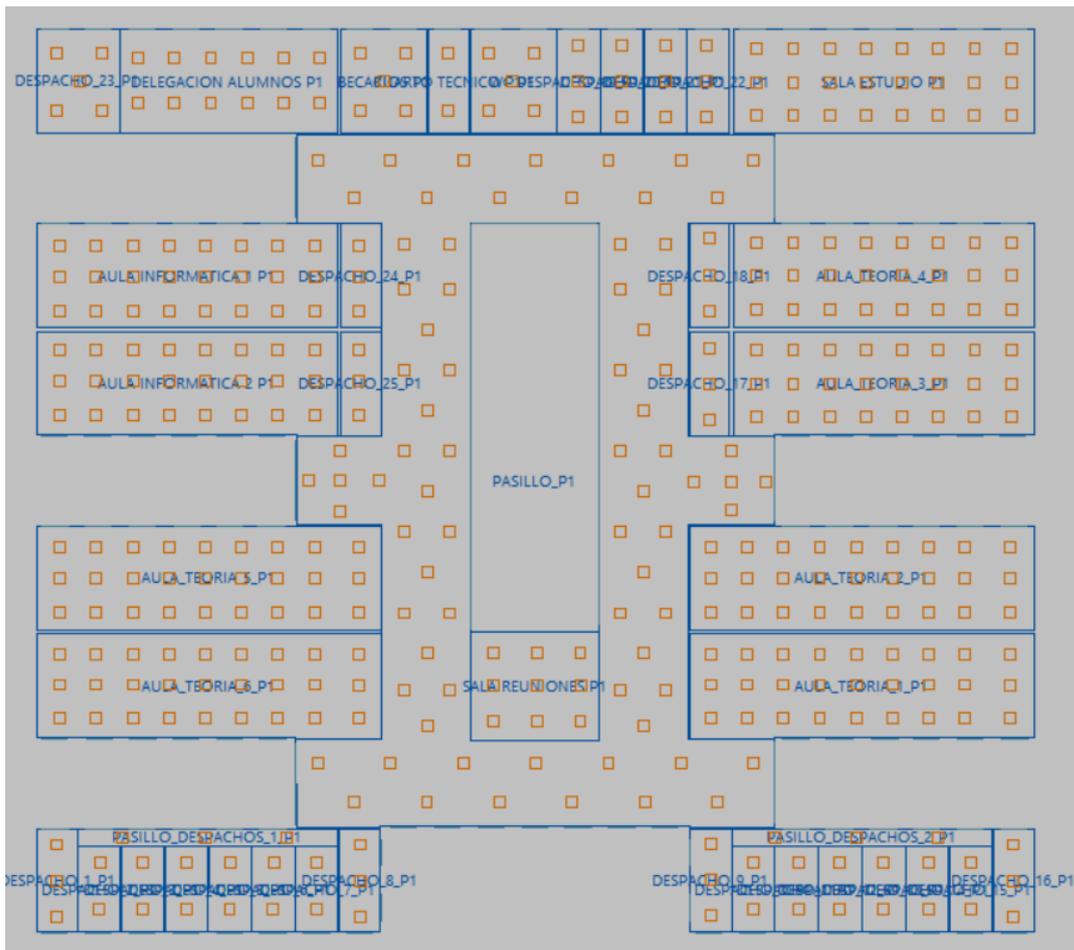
Distribución de iluminación en planta P1. Fuente: CYPE Lux
